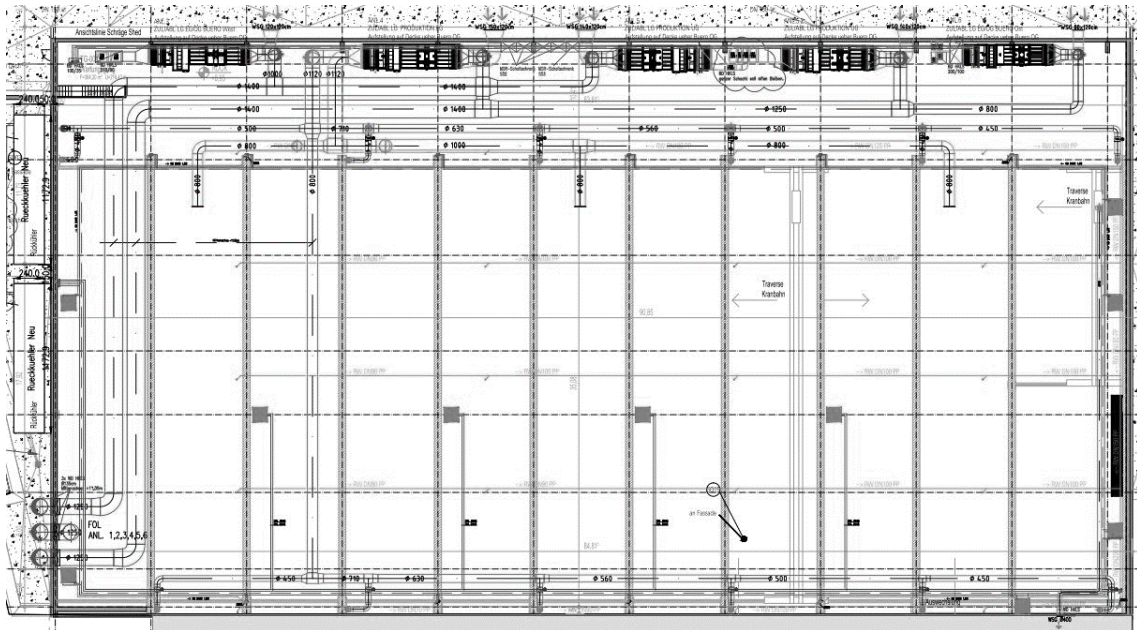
Planausschnitt Auto CAD 2D Planung¹²
